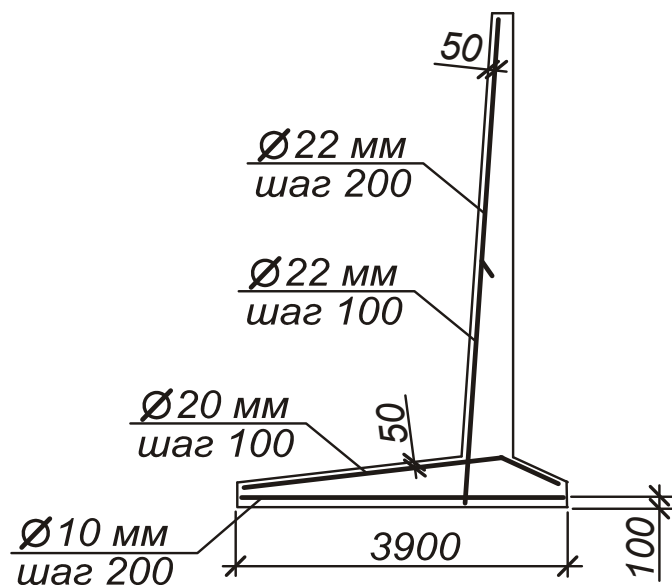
Схема армирования монолитной подпорной стены продольной рабочей арматурой
